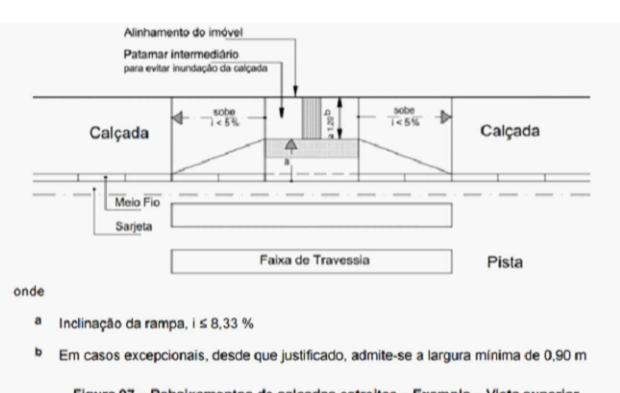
Rebaixamentos de calçadas estreitas - Exemplo - Vista superior
